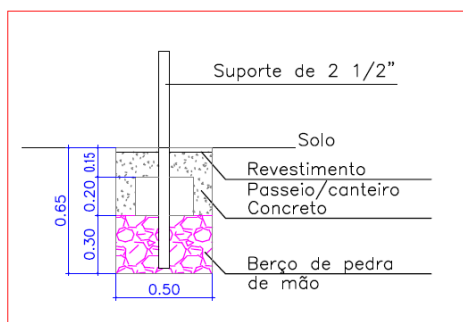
Detalhe de implantação de suporte tipo coluna
